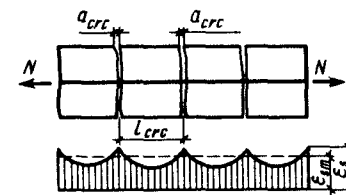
К определению ширины раскрытия нормальных трещин в растянутом железобетонном элементе
